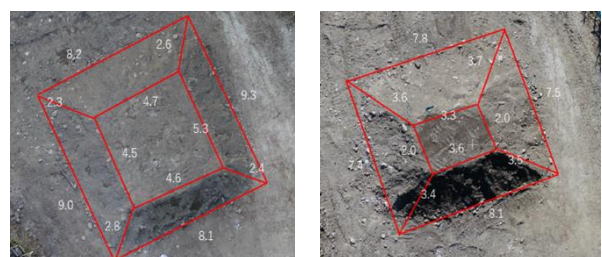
施工前の盛土 (左) と施工後の盛土 (右)
